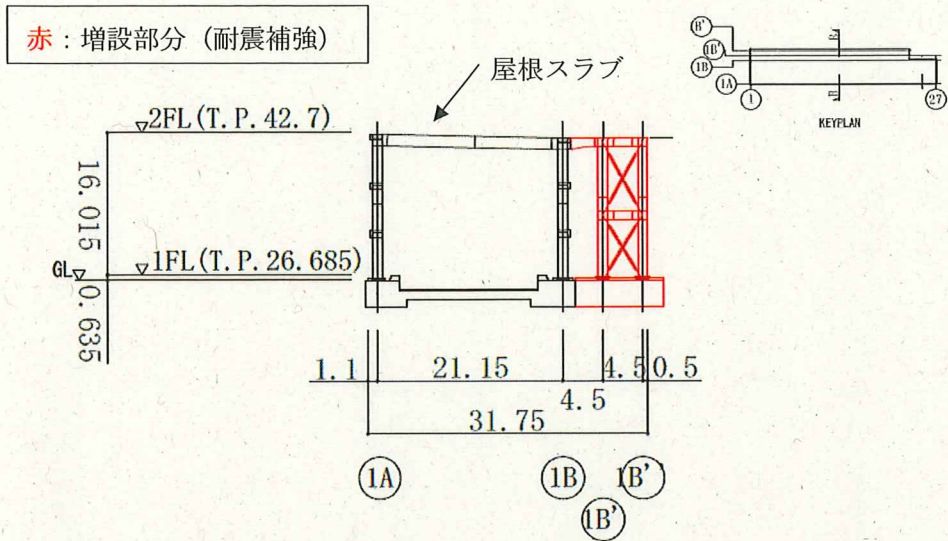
(6) B-B 断面図 (EW 方向) (単位 : m)
